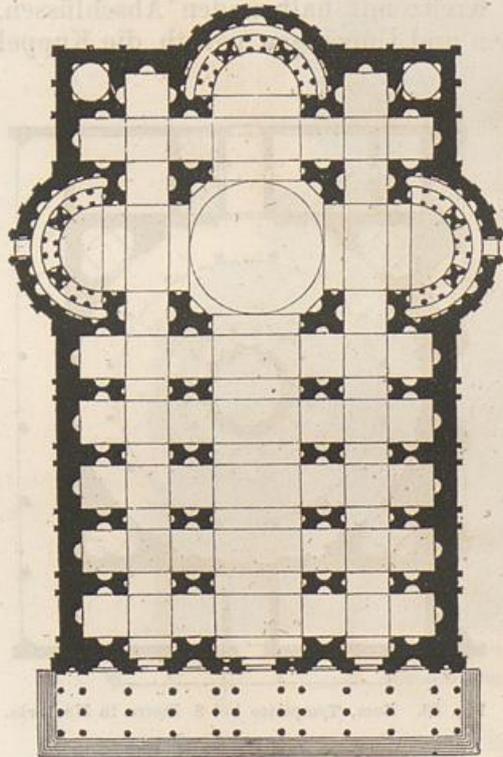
S. Peter. Rafaels Grundriss.
